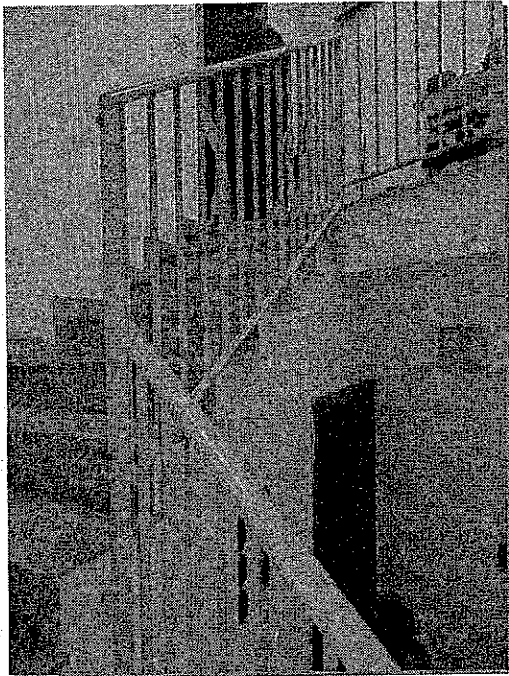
S.3 - Vista dei ingressi dei piani 1° e 2°
